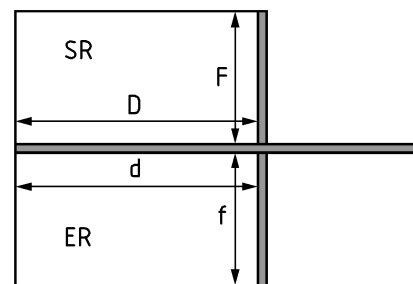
Abgewinkelte trennende und flankierende Bauteile, Grundriss
